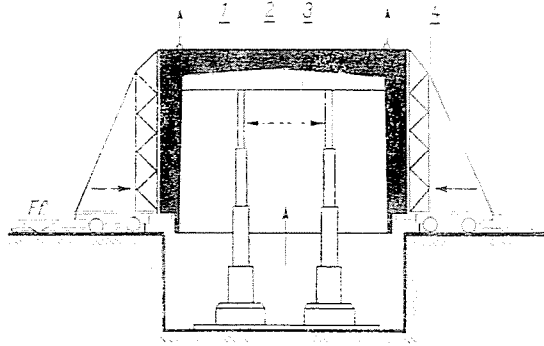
Technologisches Schema einer Anlage für die Fertigung von Raumzellen aus Stahlbeton. 1. Verlegen der Bewehrung und Einbringen des Betons; 2. hydraulisch senkbare innere Kernschalung; 3. hydraulisches Hebewerk; 4. äußere Schalungseinheiten
